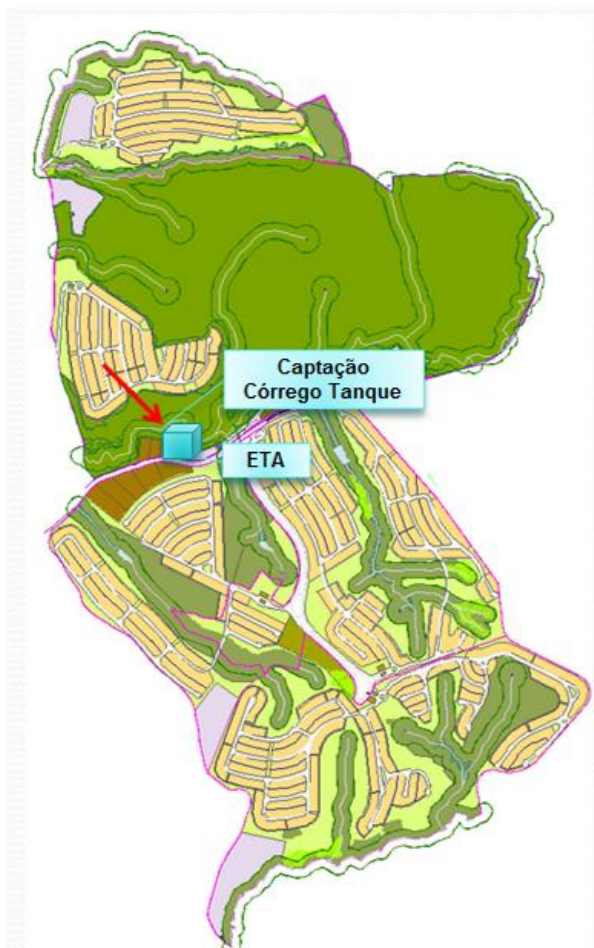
Localização do Ponto de Captação no Córrego Tanque
